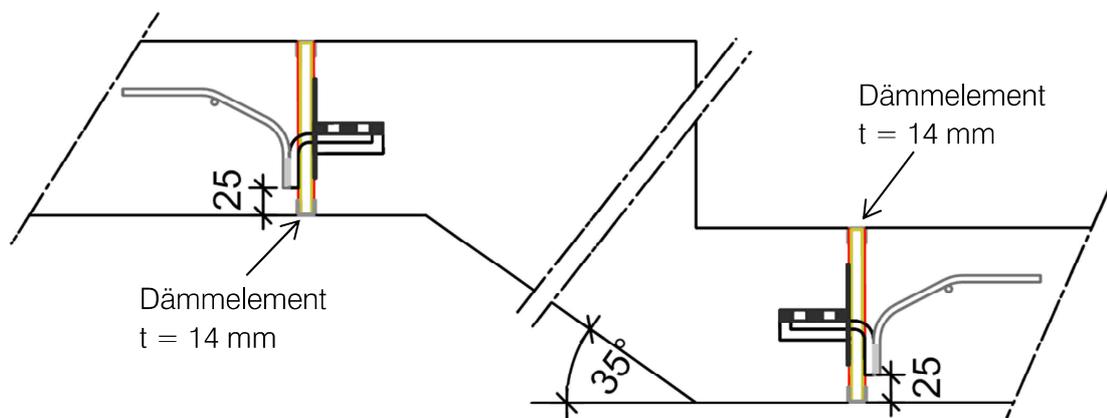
Einbausituation mit 14 mm dicken Dämmelementen in den Fugen
